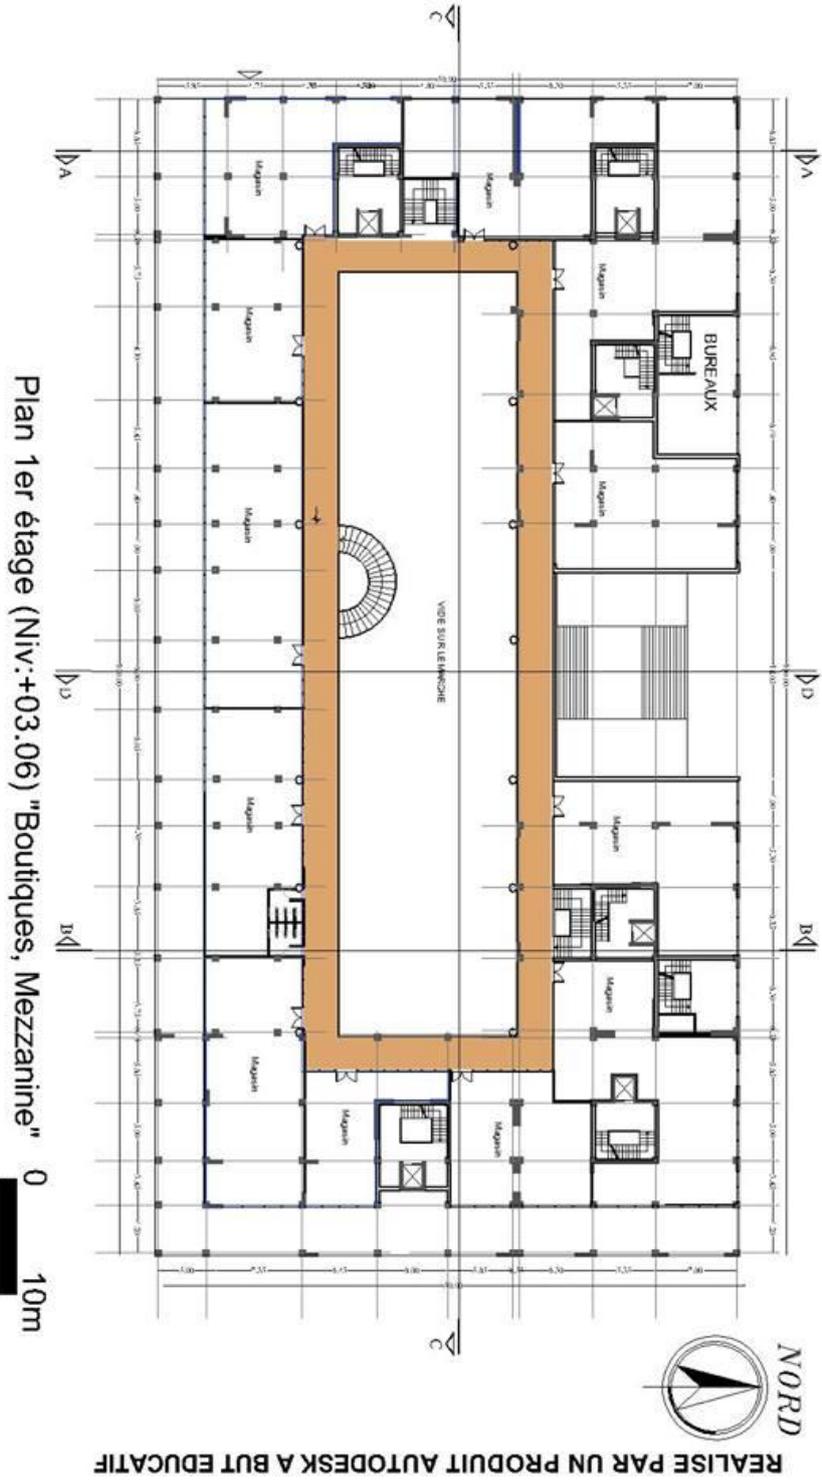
Plan 1er étage « Boutique, Mezzanine »
